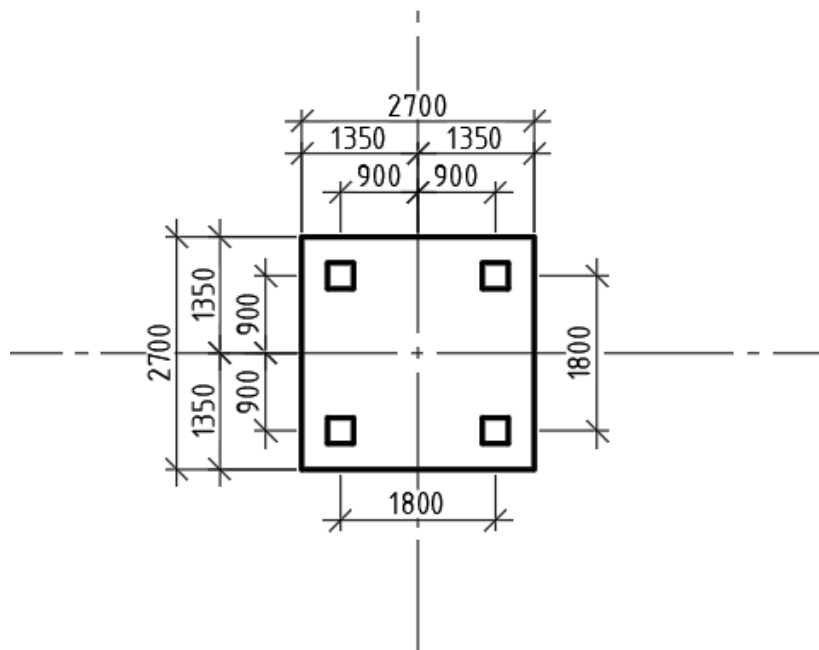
Монтажная схема свайного кустового фундамента
